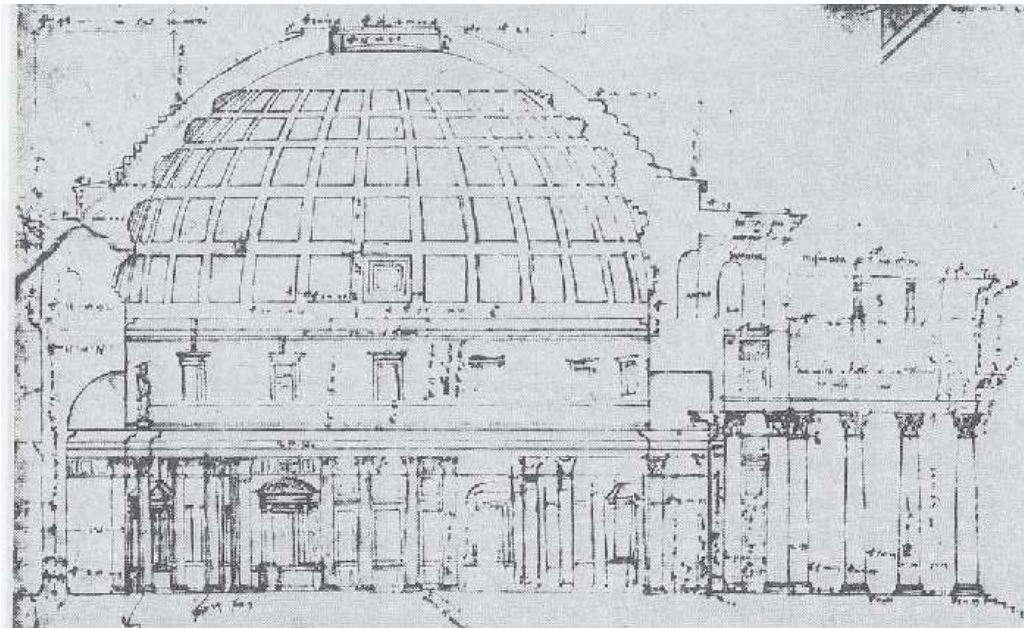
Sezione longitudinale del Pantheon - Baldassarre Peruzzi, 1511-13.
